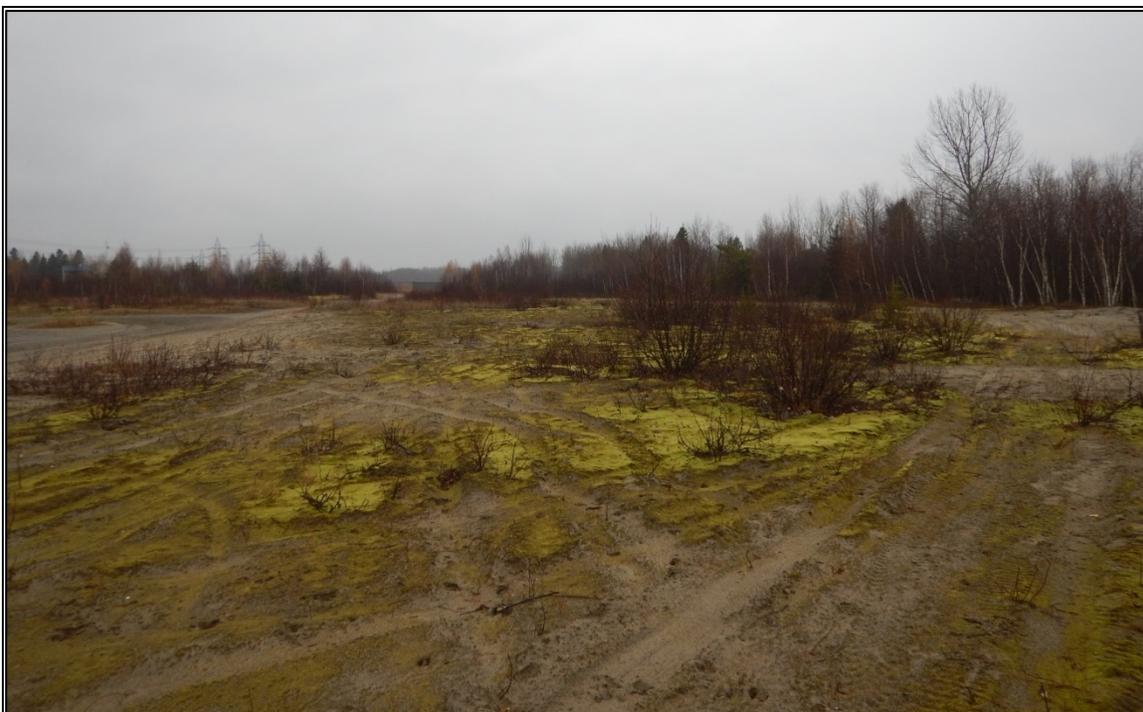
Projet 154-00-0514, emprise de la zone #3, banc d'emprunt
